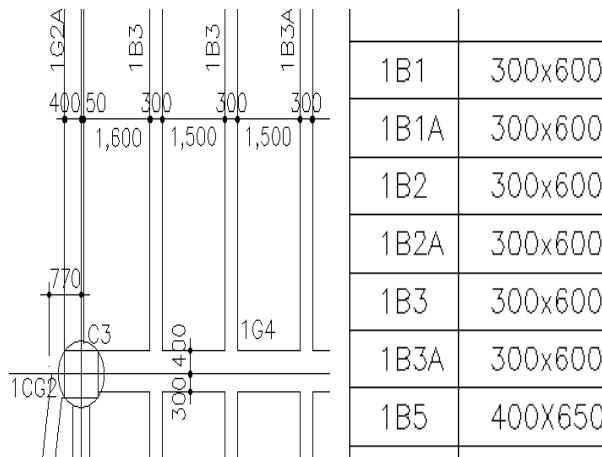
Extrait de la vue en plan des poutres secondaires constituant le plancher nervuré et ses dimensions
